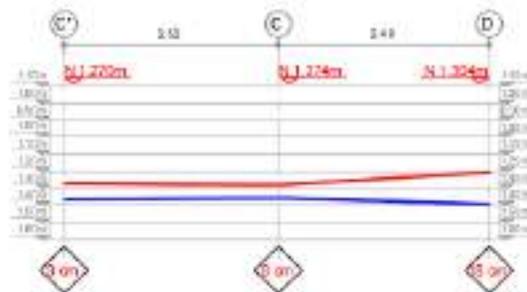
Perfiles de nivelación ejes 2, 3 – Casa No. 5 primer piso.
